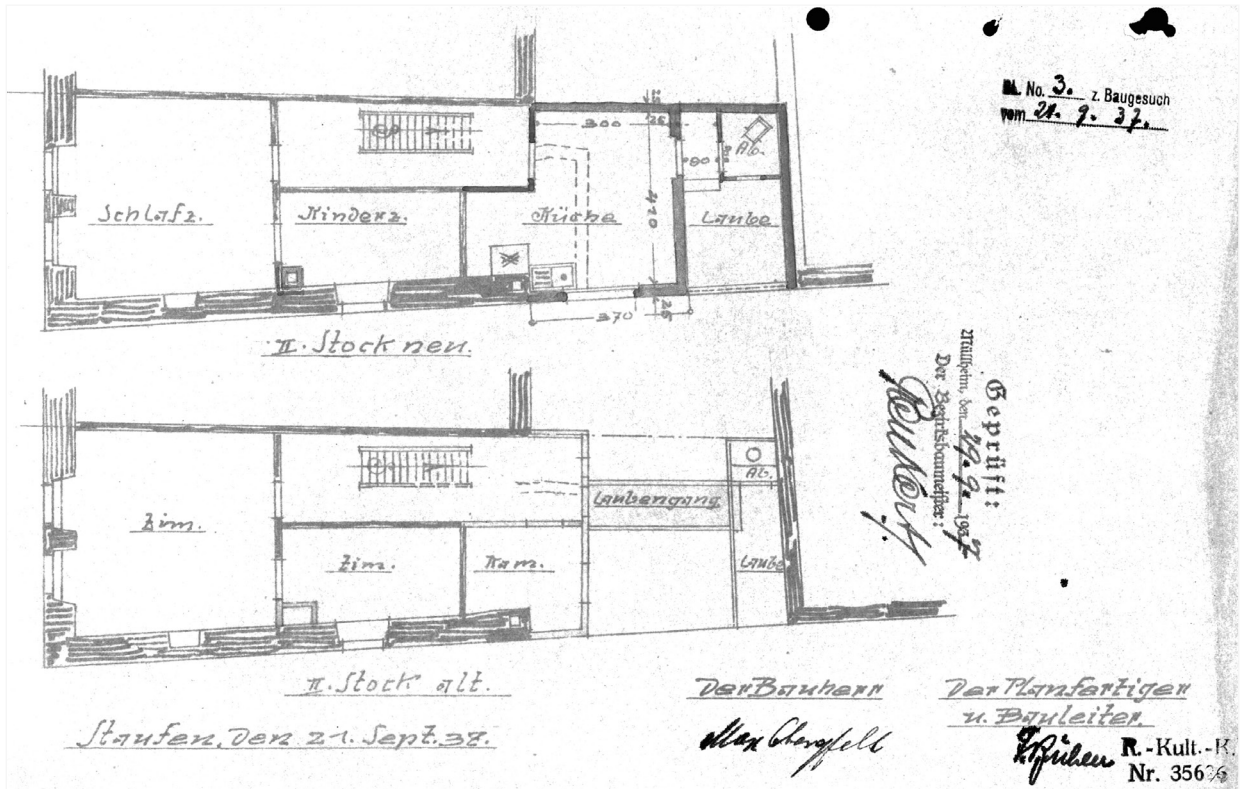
Hauptstraße 31, Grundriss 1. Obergeschoss, Zustand und Neuplanung von 1937.
